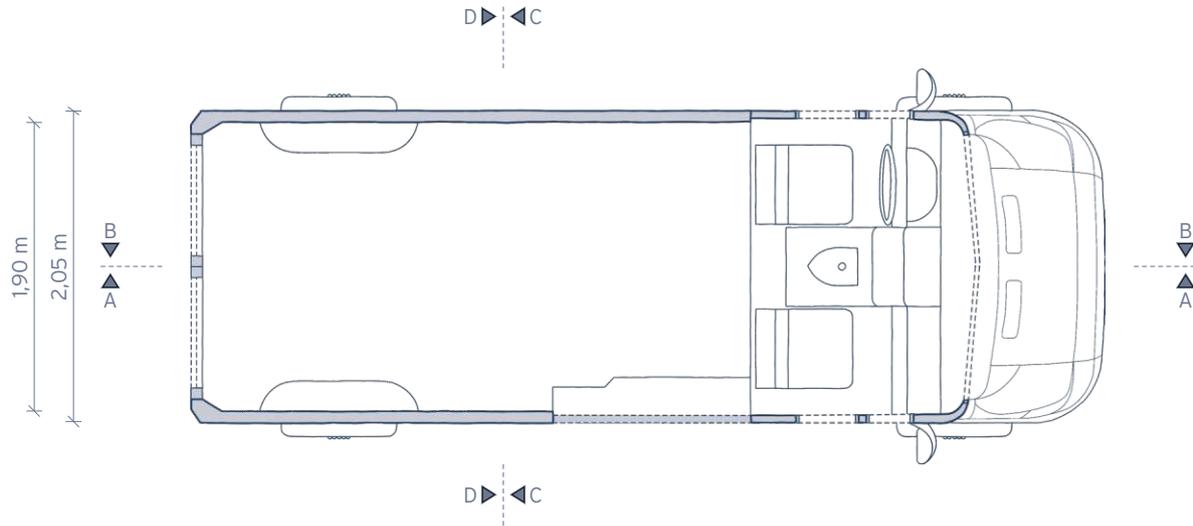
Fiat Ducato L4H3 Grundriss (Maßstab 1:50)
